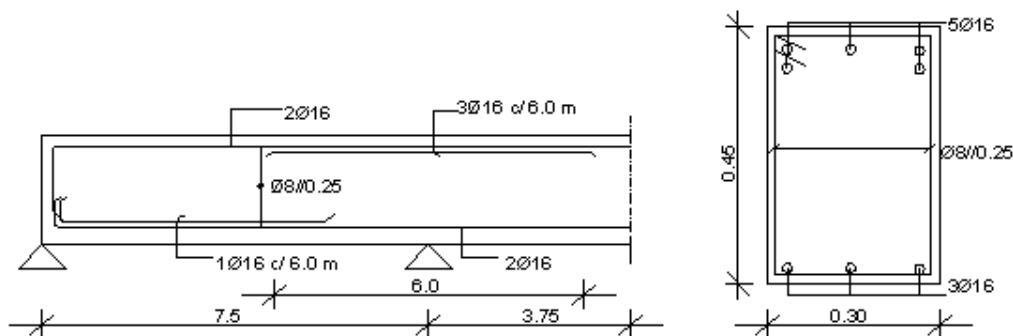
Pormenorização da viga LC30/33 em perfil longitudinal (à esquerda) e em corte transversal (à direita)
